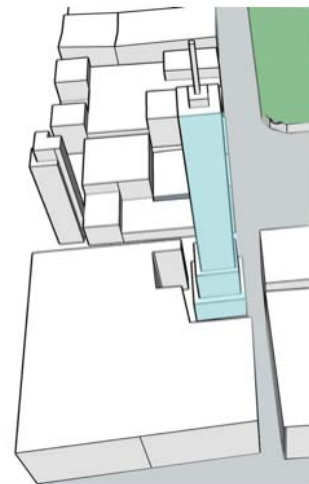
Fachadas esquemáticas Torre Latinoamericana. Fachadas de cristal y aluminio homogéneas, doble cristal de 6mm. Elaboración propia.
